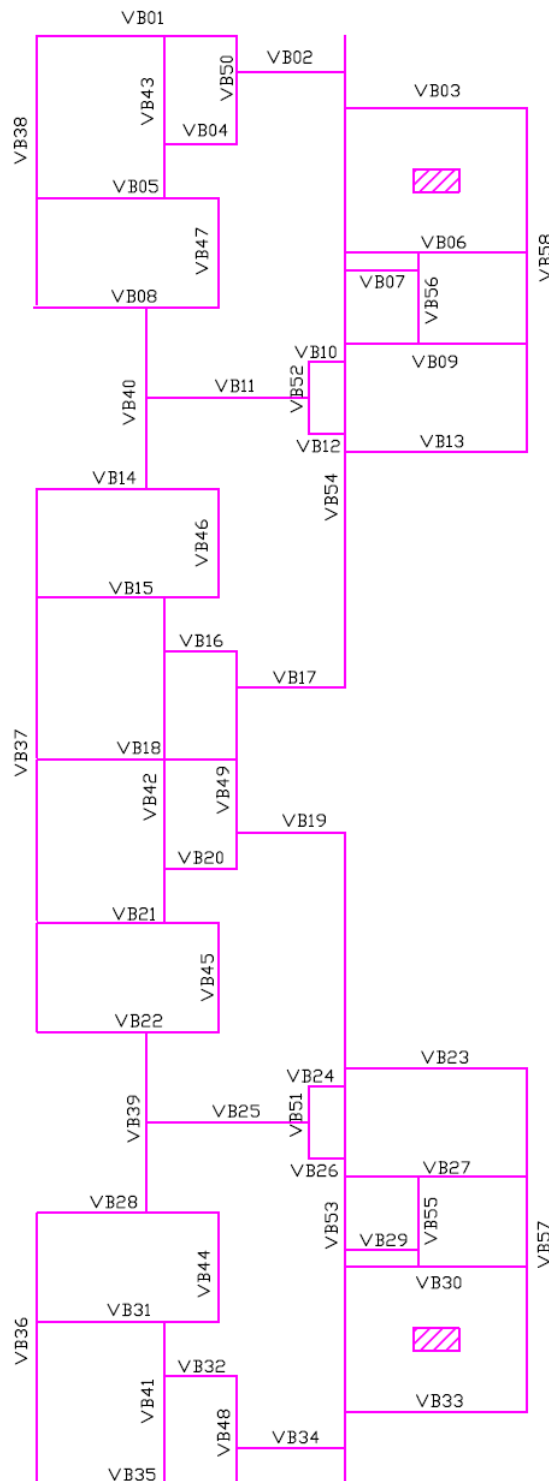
Vigas baldrame do edifício alongado com fundação rasa.
